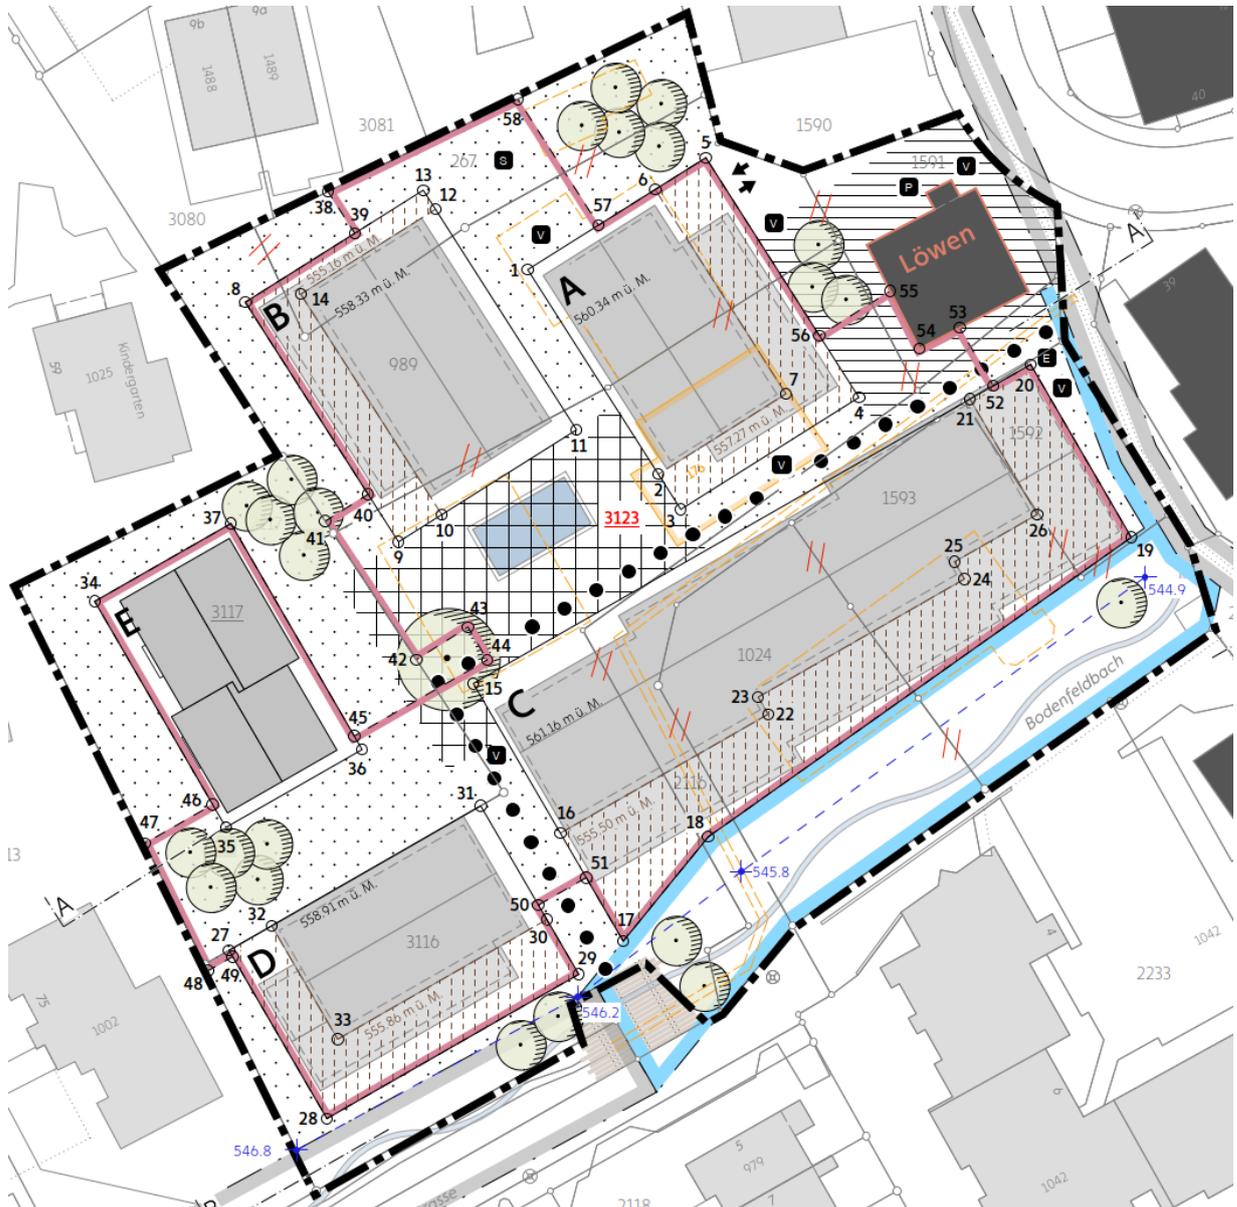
Situationsplan des Gestaltungsplans «Am Bodenfeldbach» (Ausschnitt), 27.01.2025; Planverfasser: Planwerkstadt AG, Zürich
